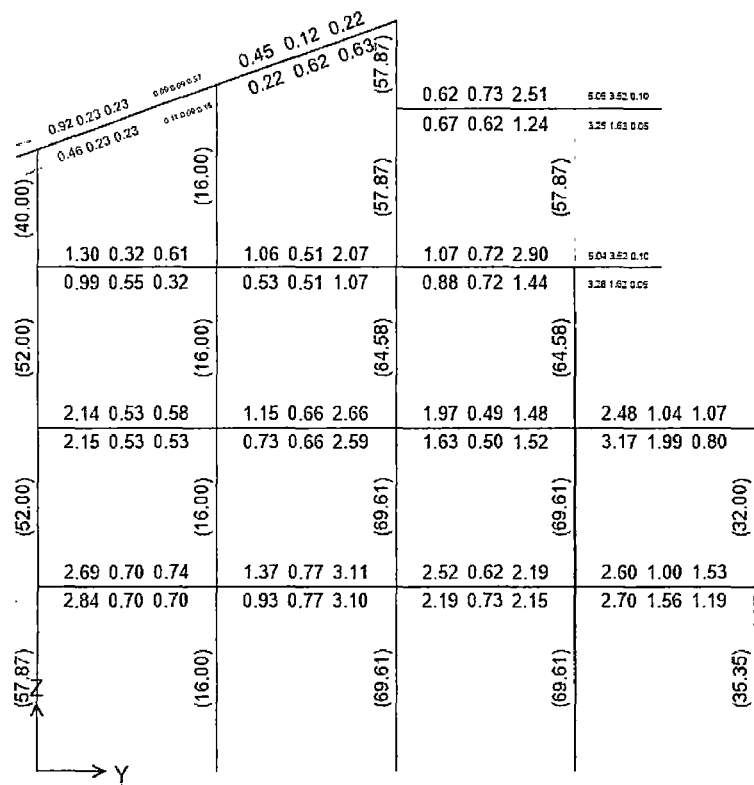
Eje 7-7, calculo por chequeo de acero de la estructura existente.
